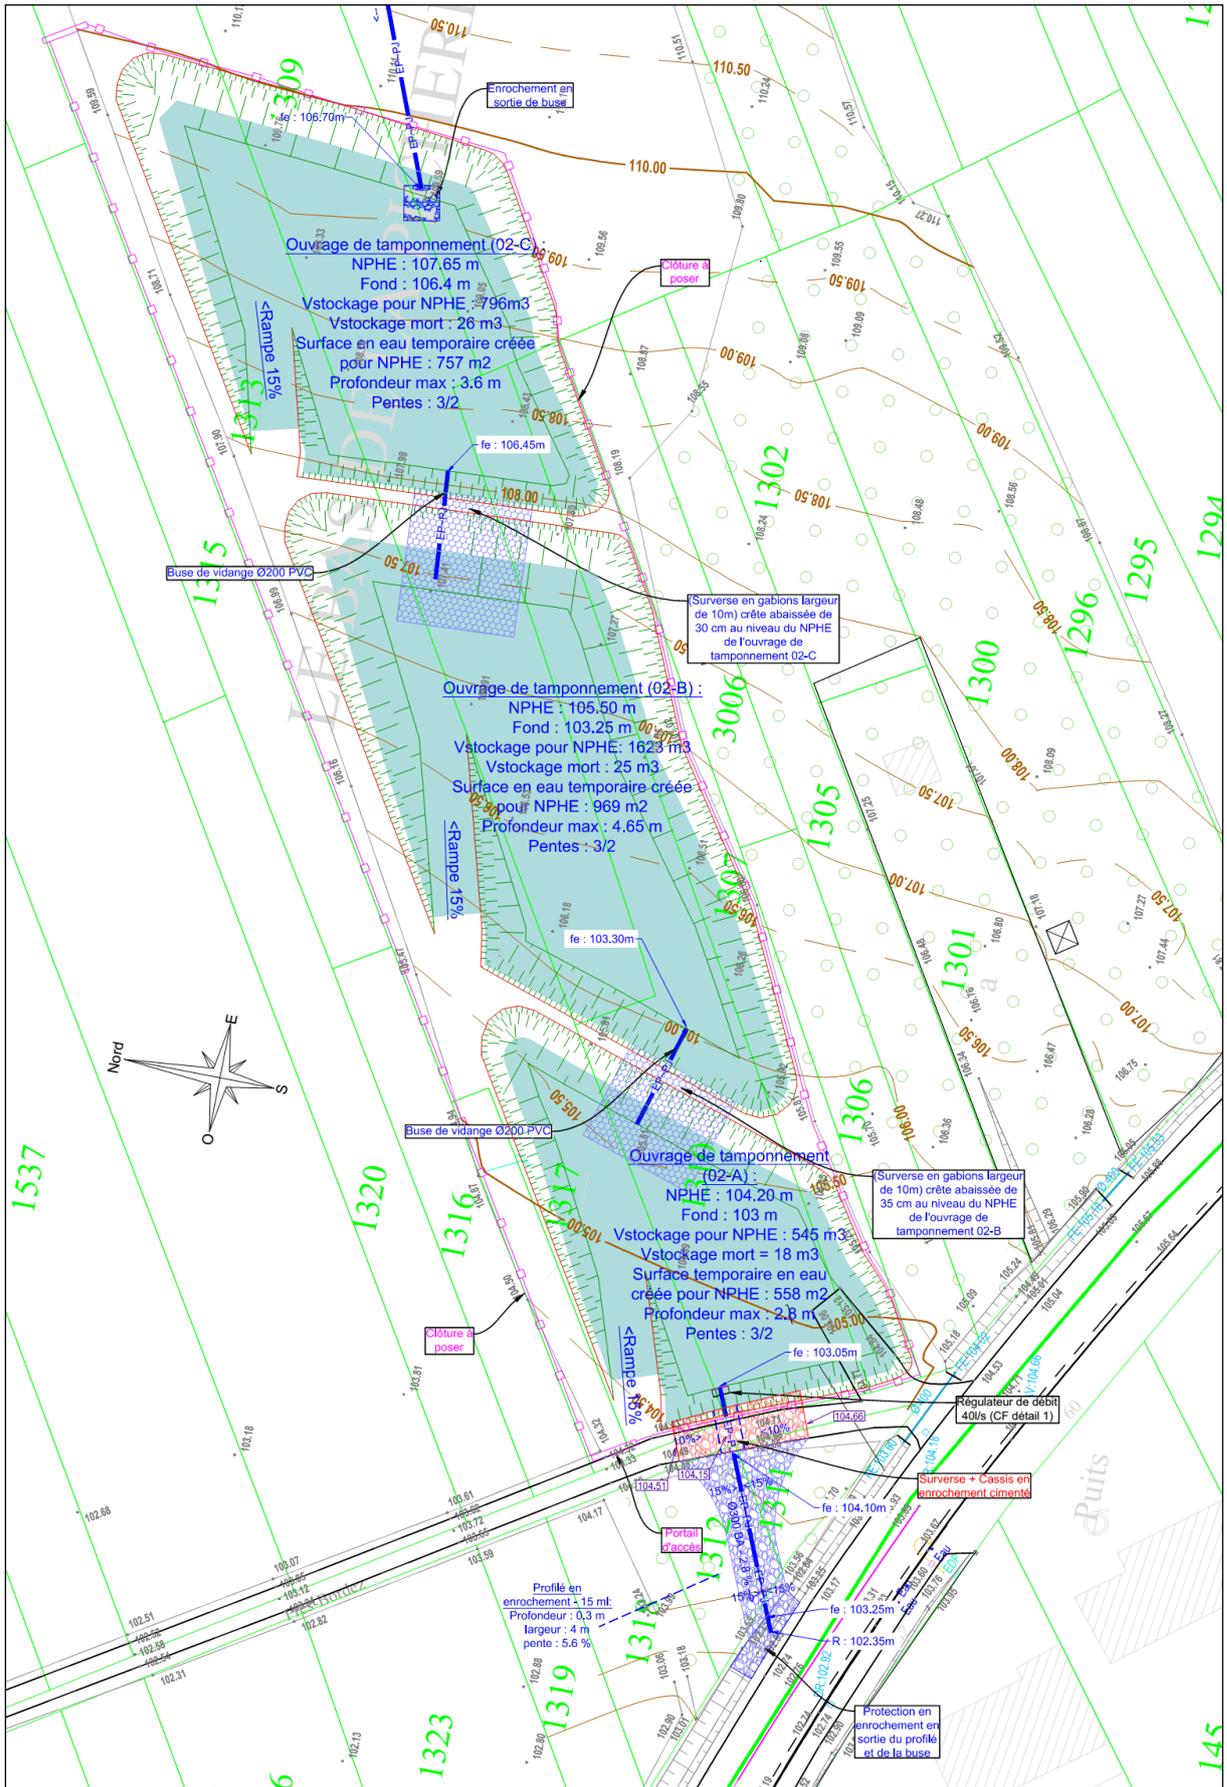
Extrait du plan de masse - Ouvrage de tamponnement n°002
